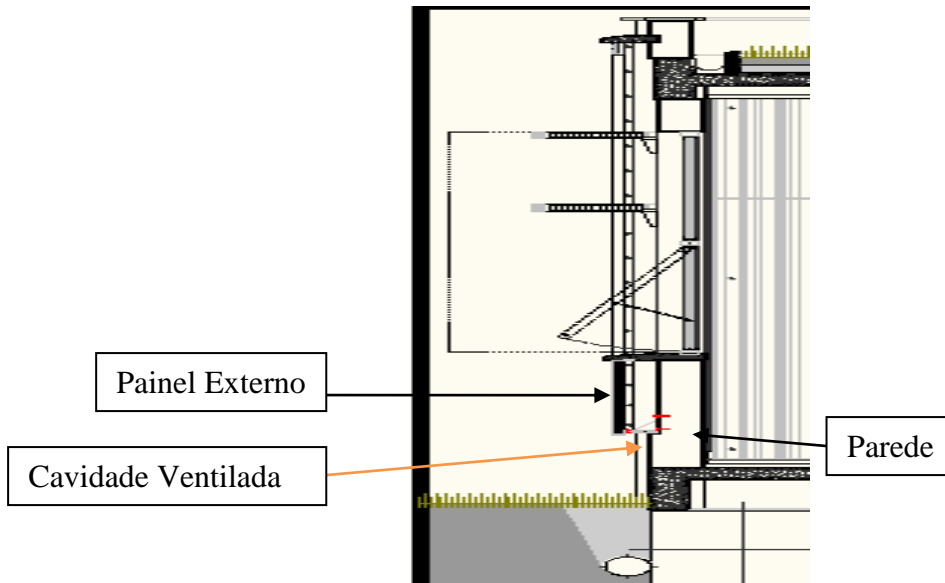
Fachada ventilada em corte (Krebes,2010)
